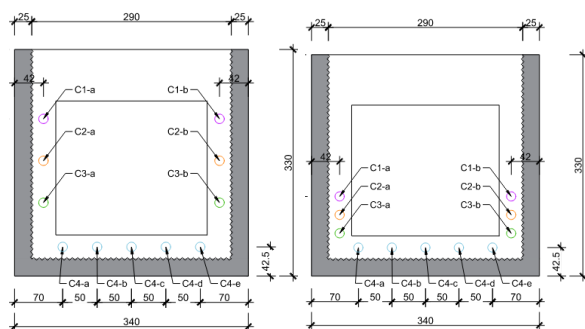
Disposición de las vainas de pretensado en los dinteles de las pilas pórtico
